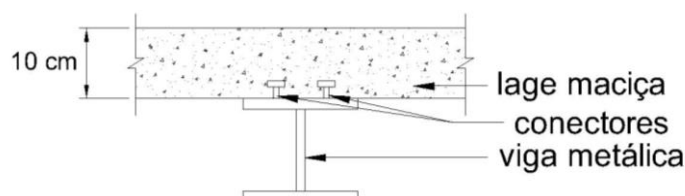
Seção transversal da viga mista utilizando laje maciça (Autora (2017))
